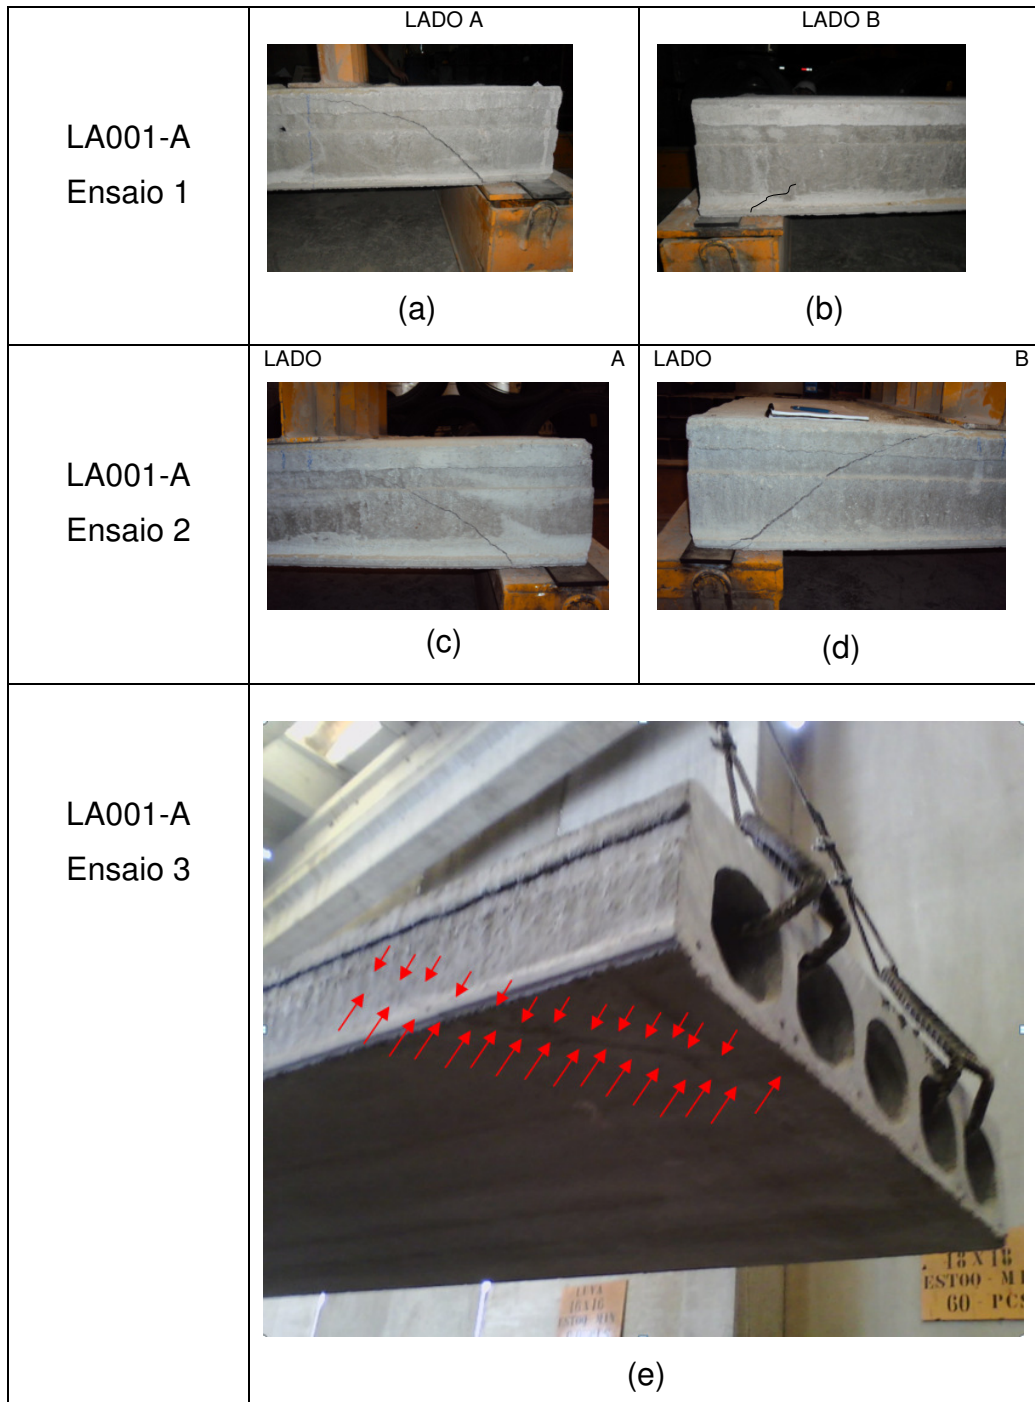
FISSURAS DAS LAJES LA001-A APÓS OS ENSAIOS.
